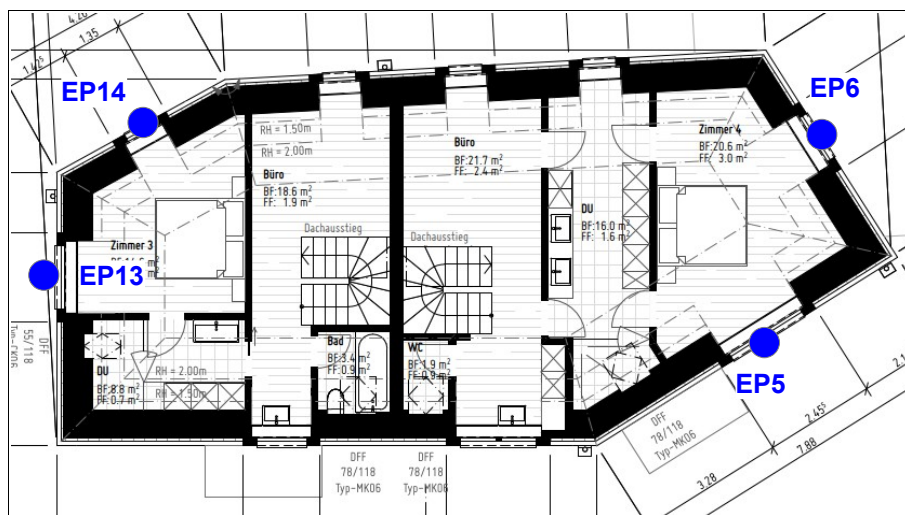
Grundriss DG, ohne Mst.; Quelle: Architekt
